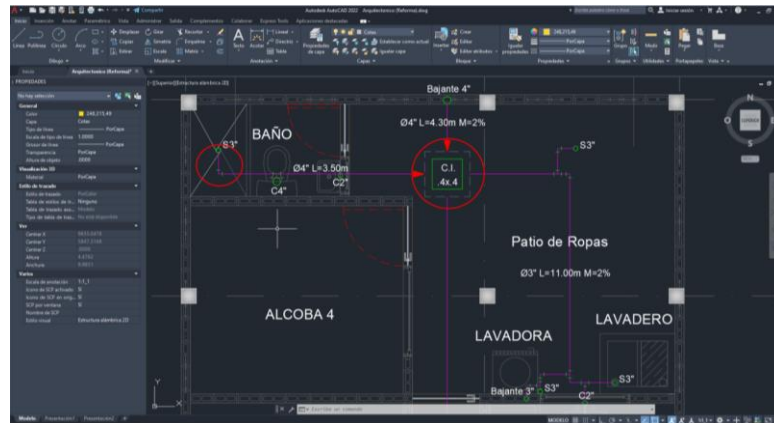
Vista de los elementos de la red hidráulica y sanitaria. AutoCAD. Fuente elaboración propia.
